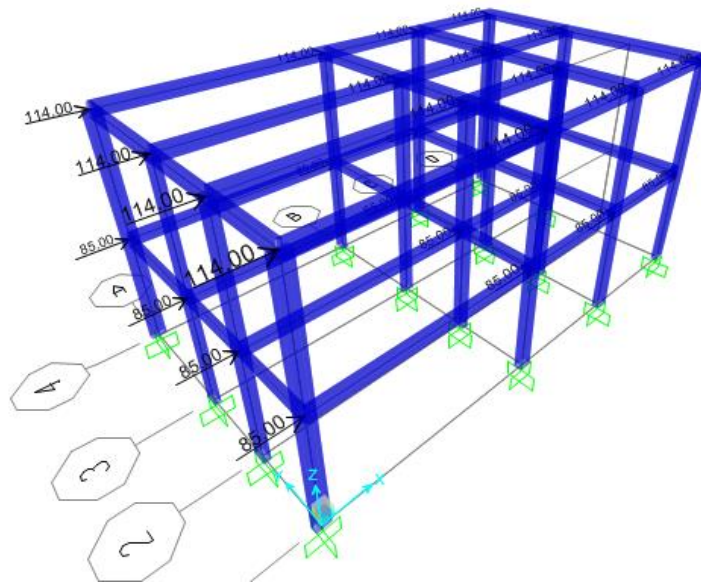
Fuerzas horizontales de sismo en la dirección X
